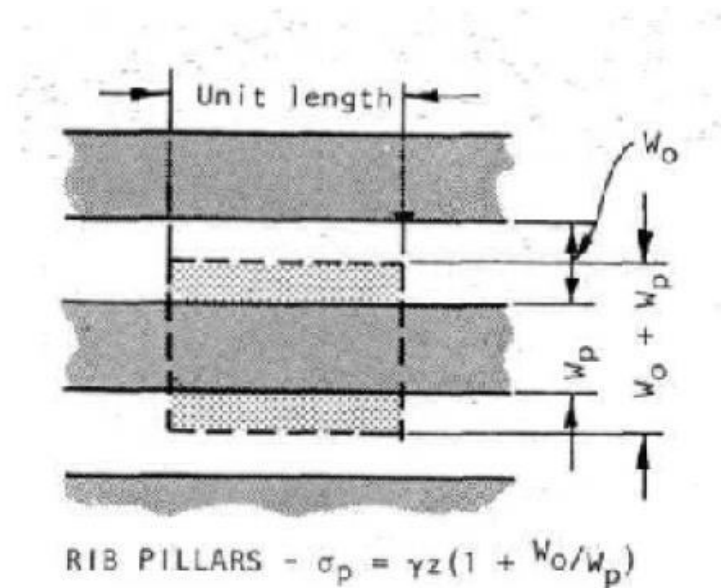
Vista in pianta del sistema di scavo a camere e diaframmi.
